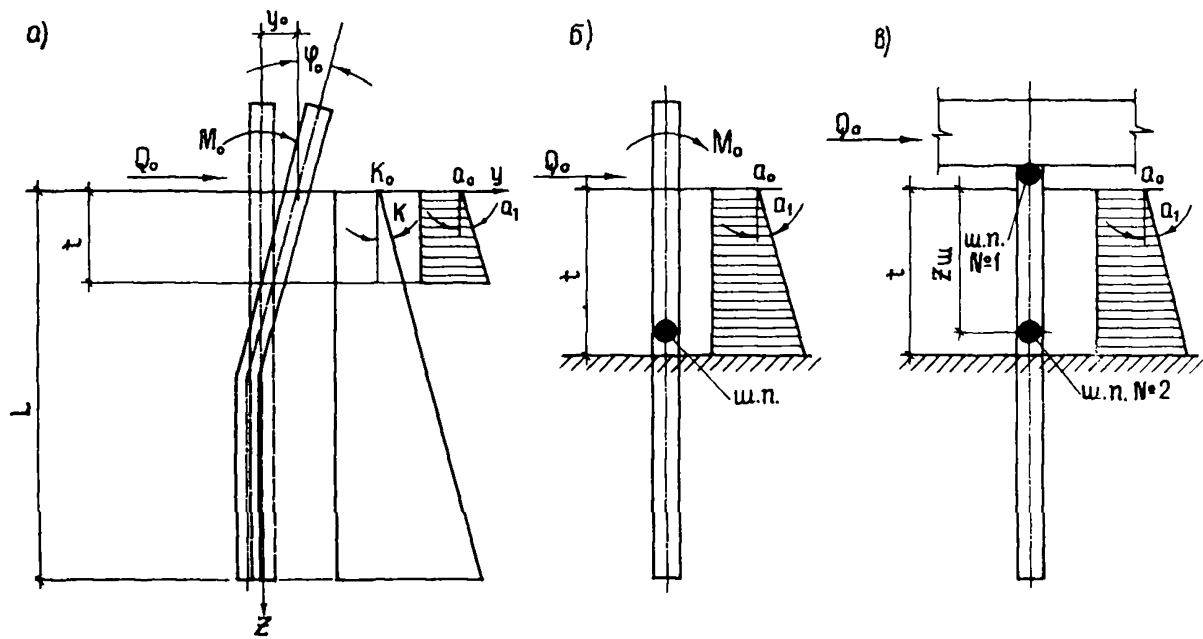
Расчетная схема системы горизонтального нагружения свая-грунт (глинистый грунт)
